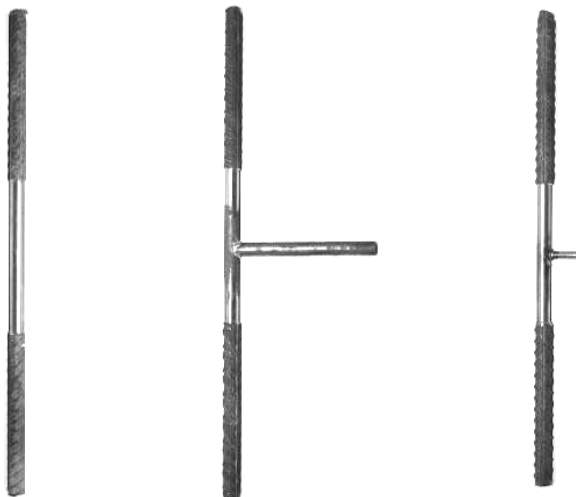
Drei Probestücke für Zugprüfungen, links: Referenzstab, Mitte: Stab mit angelötetem Bolzen, rechts: Stab mit aufgeschweißtem Gewindebolzen.
